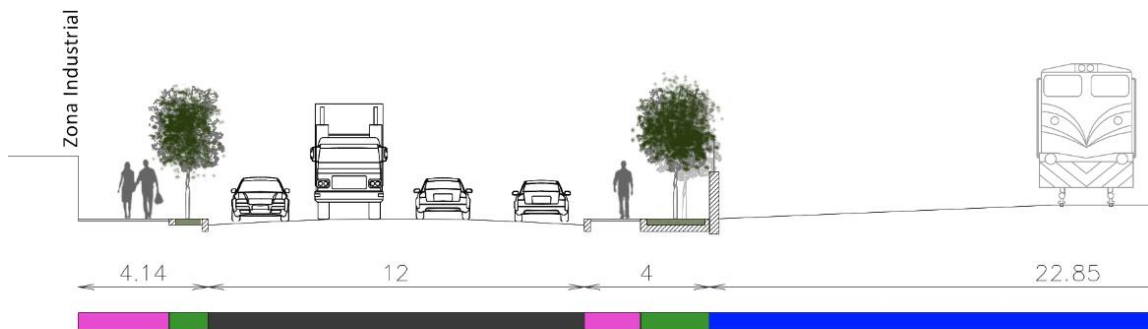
Detalle sección del lado izquierdo de las vías. Fuente: Elaboración propia
